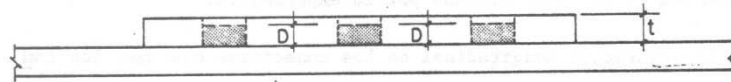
REQUISITOS PARA SOLDADURAS DE FILETE
